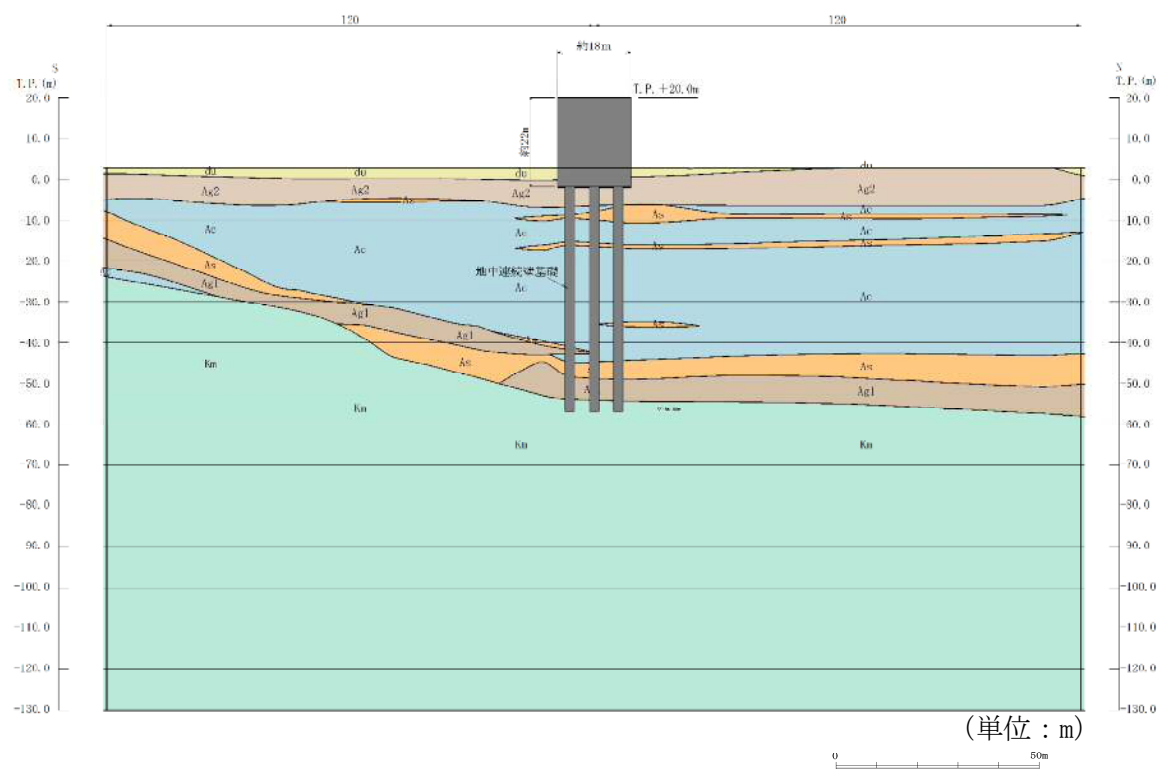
(5) 鉄筋コンクリート防潮壁 断面図(E-E断面)
